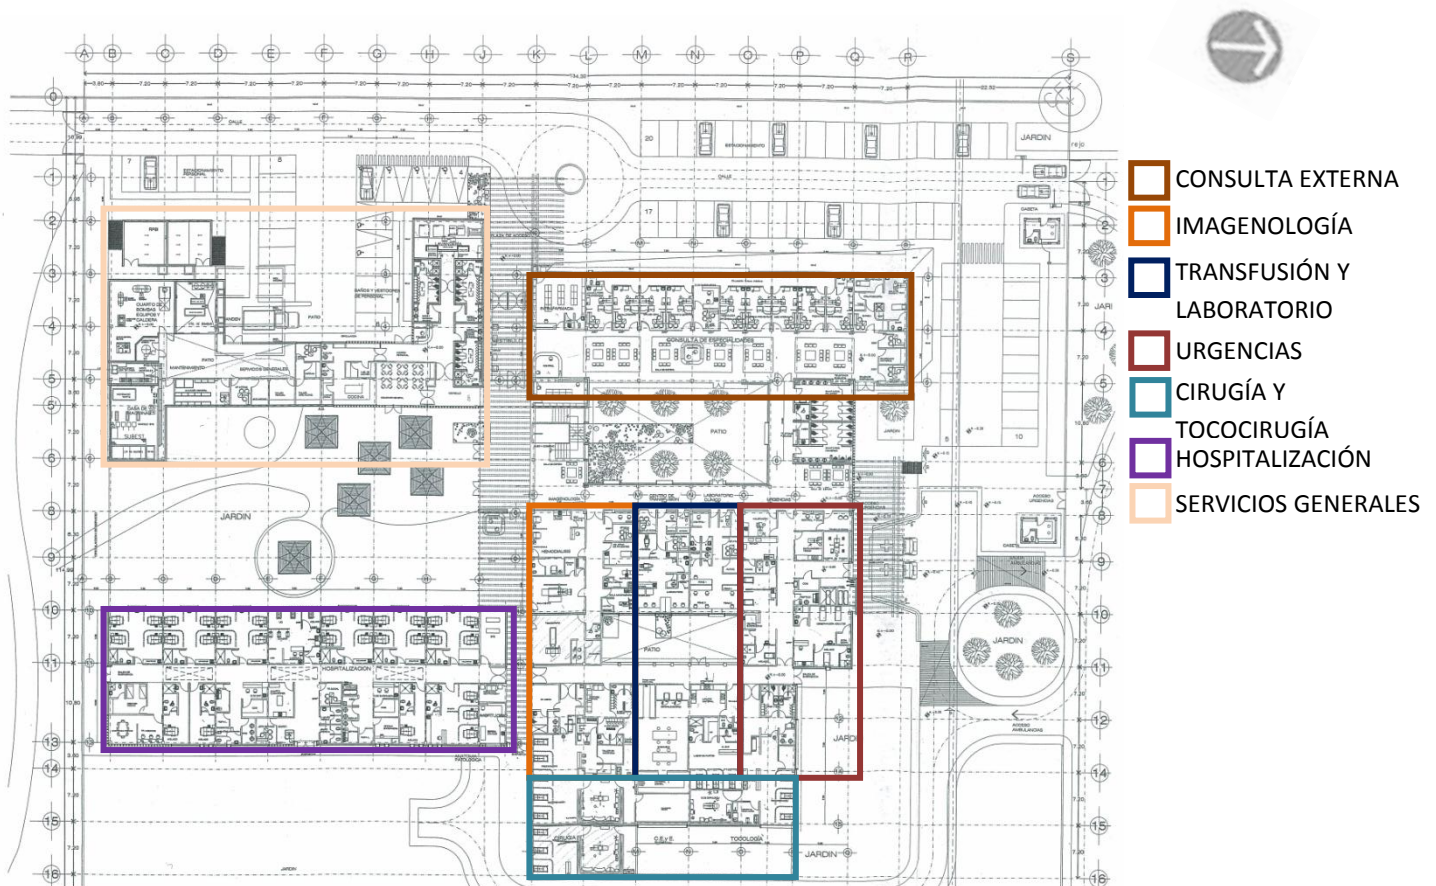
Planta Arquitectónica Hospital Caborca. S/E Fuente: Secretaría de Salud Pública.
